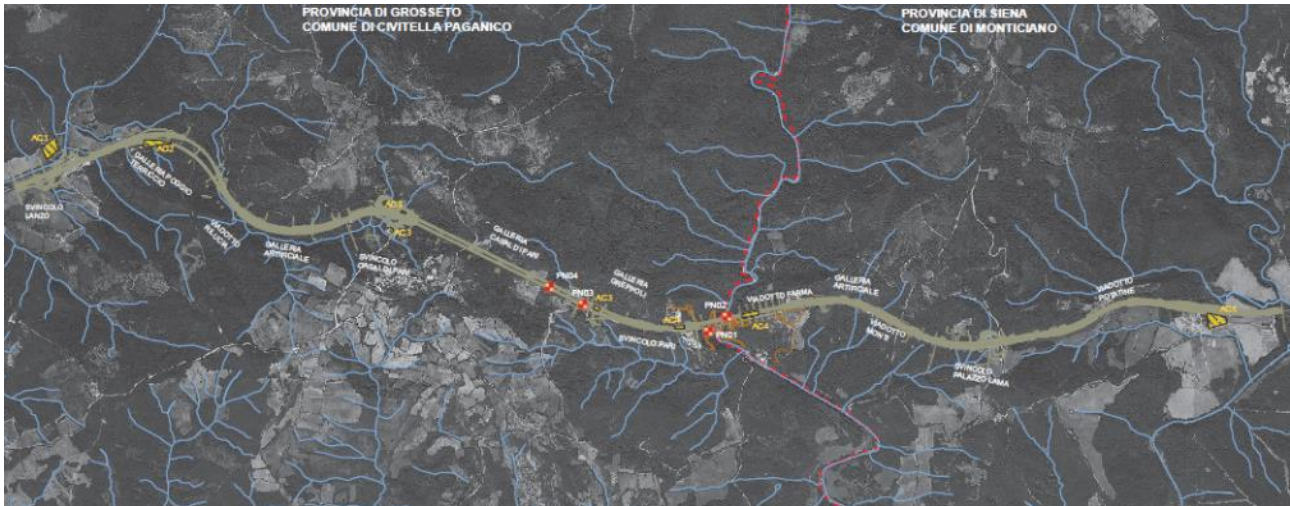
Planimetria generale – acque sotterranee / Piezometri
